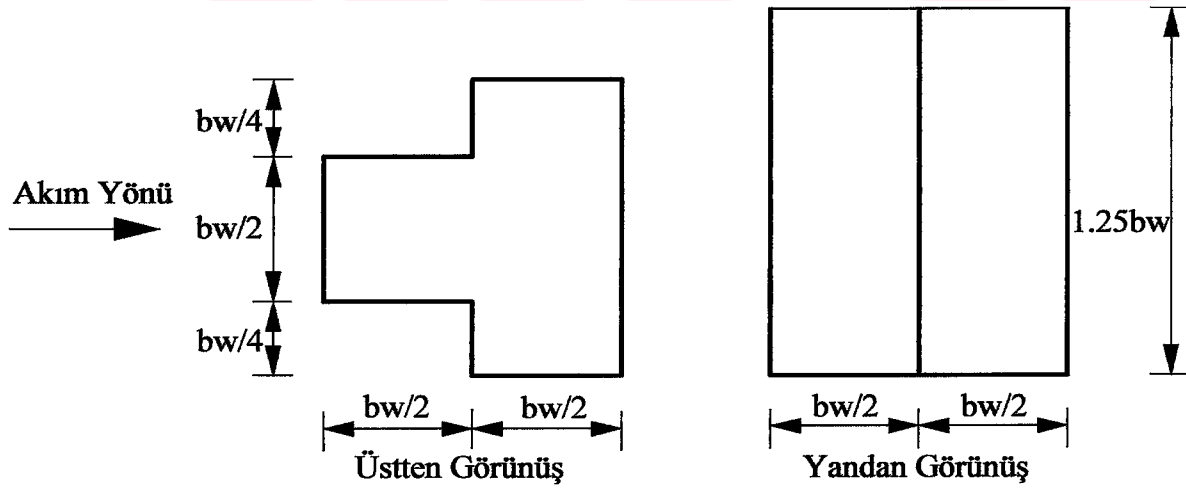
Deneyde kullanılan 24. tip enerji kırıcı blok
